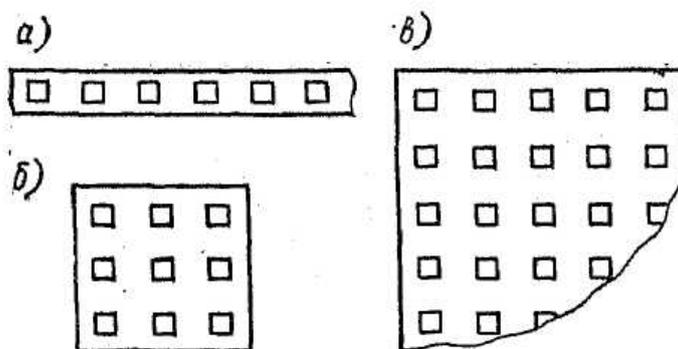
Виды свайных фундаментов в зависимости от размещения свай в плане: а – ленточный; б – свайный куст; в – сплошное свайное поле
